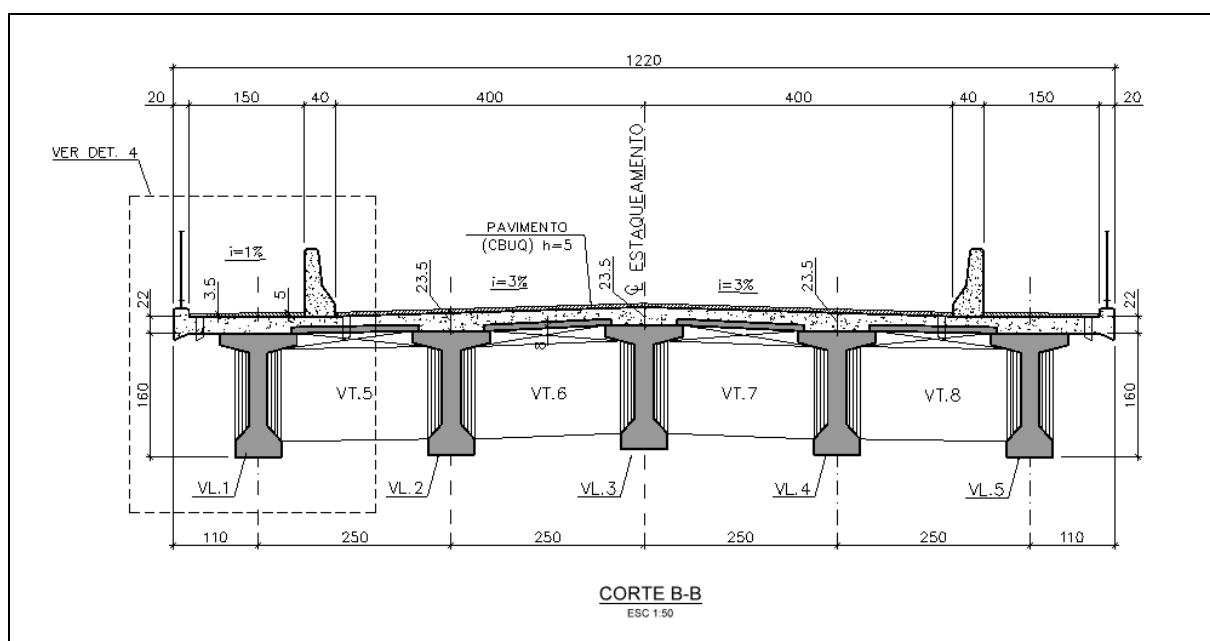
Seção transversal típica no trecho isostático (vigas pré-moldadas)
